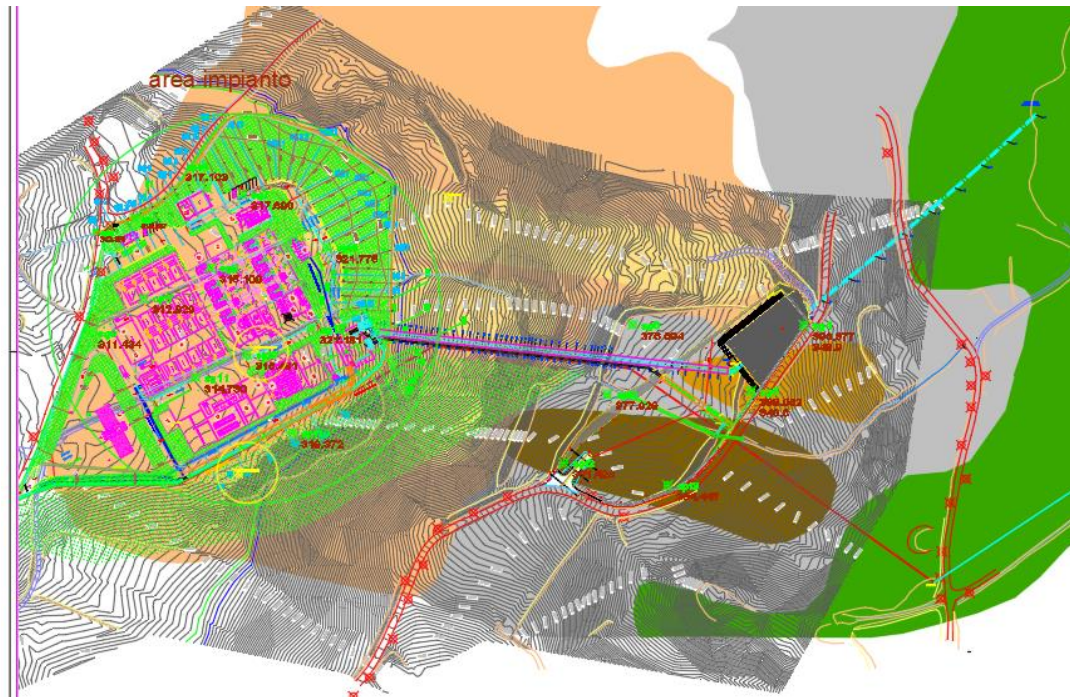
Rilievo planimetrico con la rappresentazione della condotta forzata e dell'area impianti
